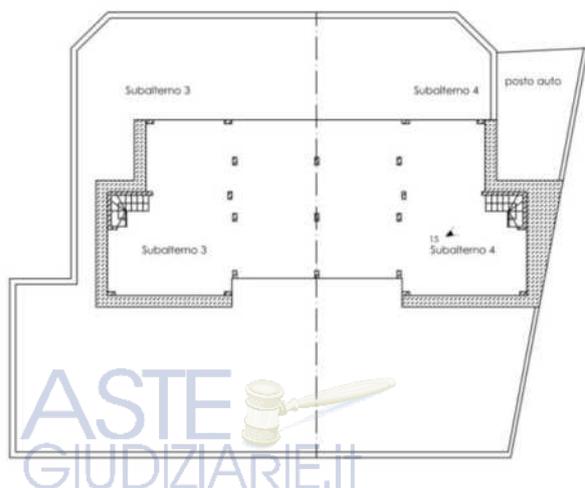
Schema planimetrico piano T come da allegato 11a alla presente relazione.
